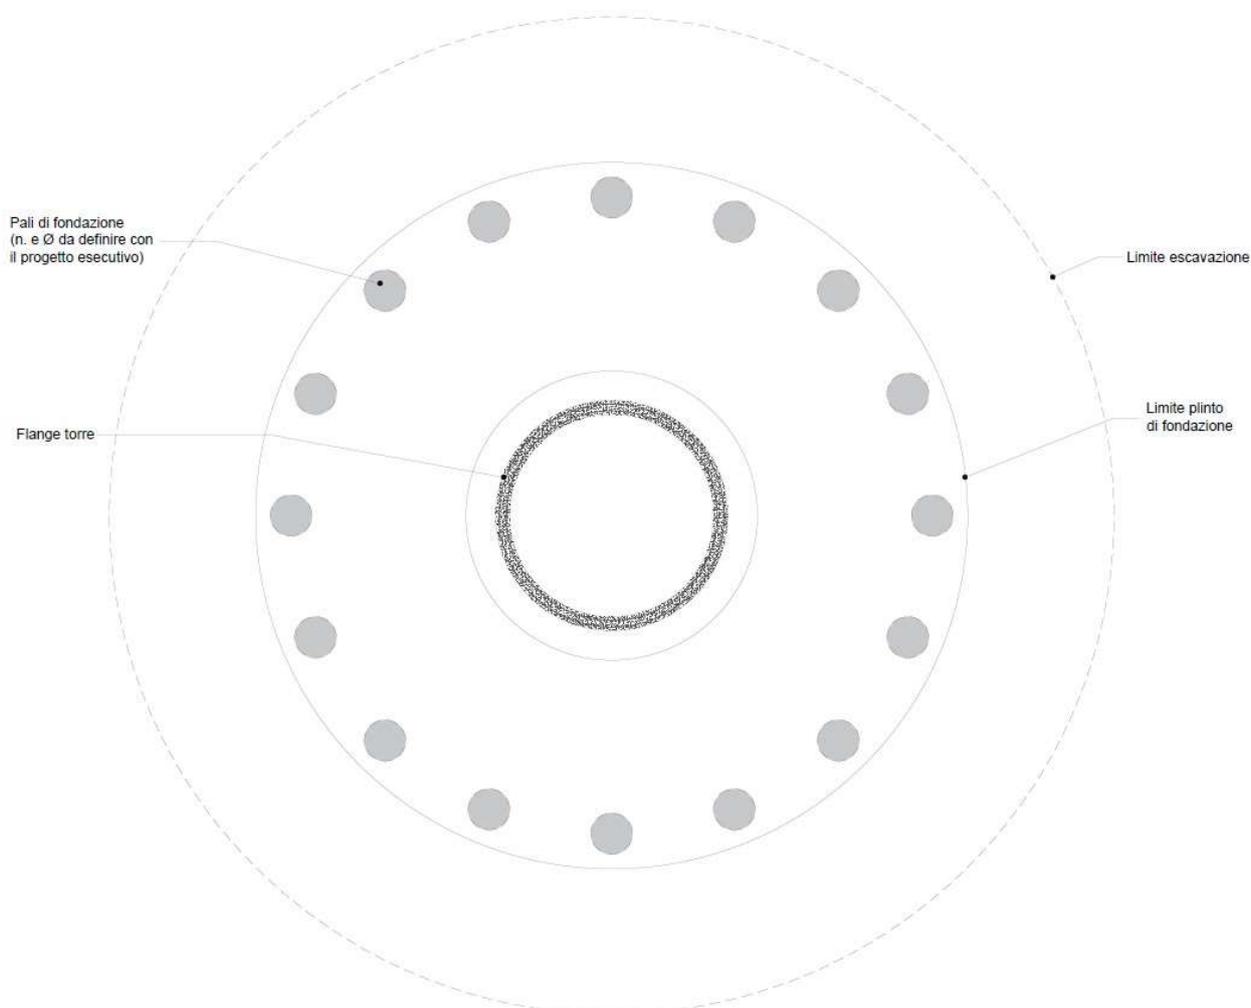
Tipico aerogeneratore - piastra di fondazione
